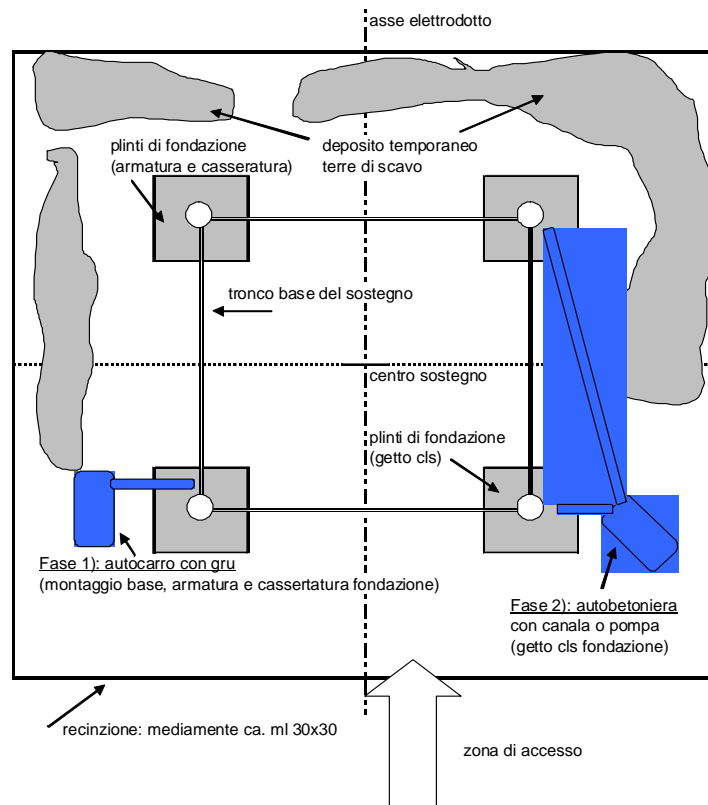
Planimetria dell'Area Sostegno (getto e basi)
